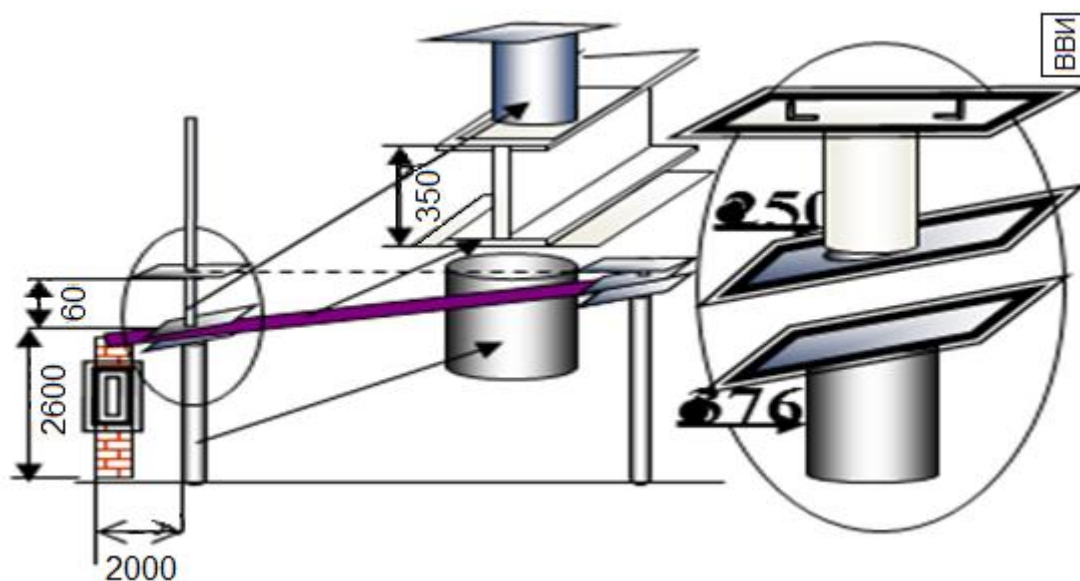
Схема элементов для надстройки 2-го этажа при реконструкции фермы, реабилитируемой в жилой дом
